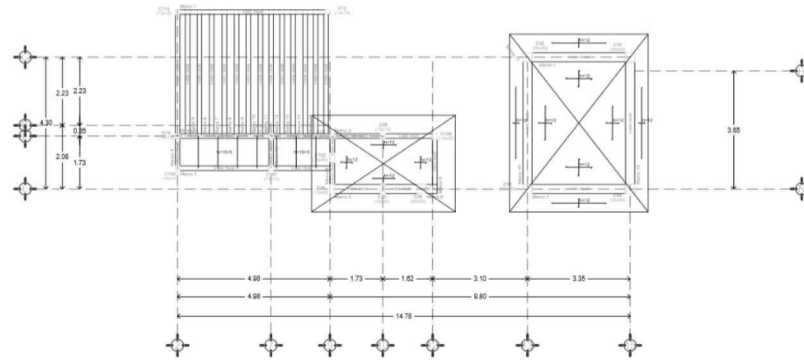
Plantas estructurales de losa segundo nivel, con sus respectivos trabes y cadenas.
